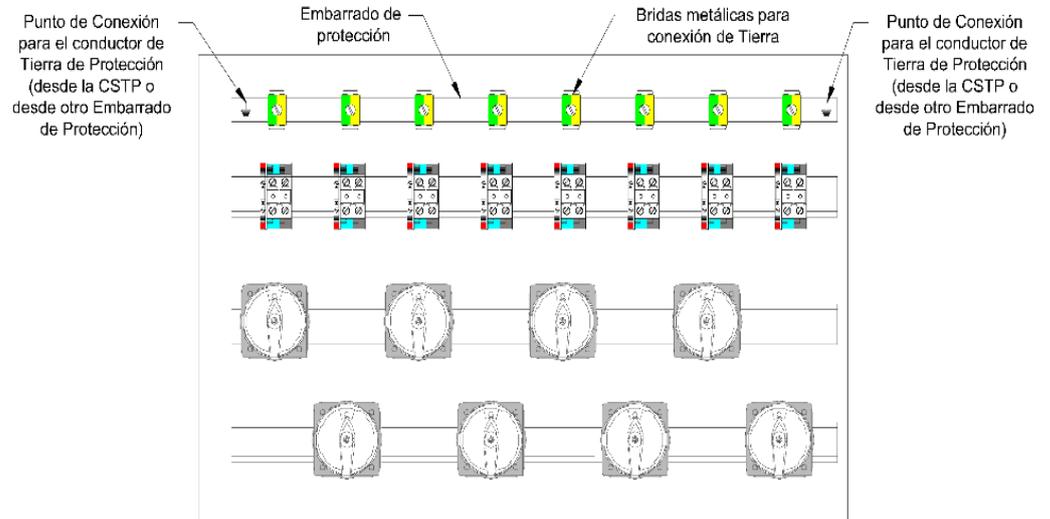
Embarrado de Protección para el Módulo de Salida de la CC
